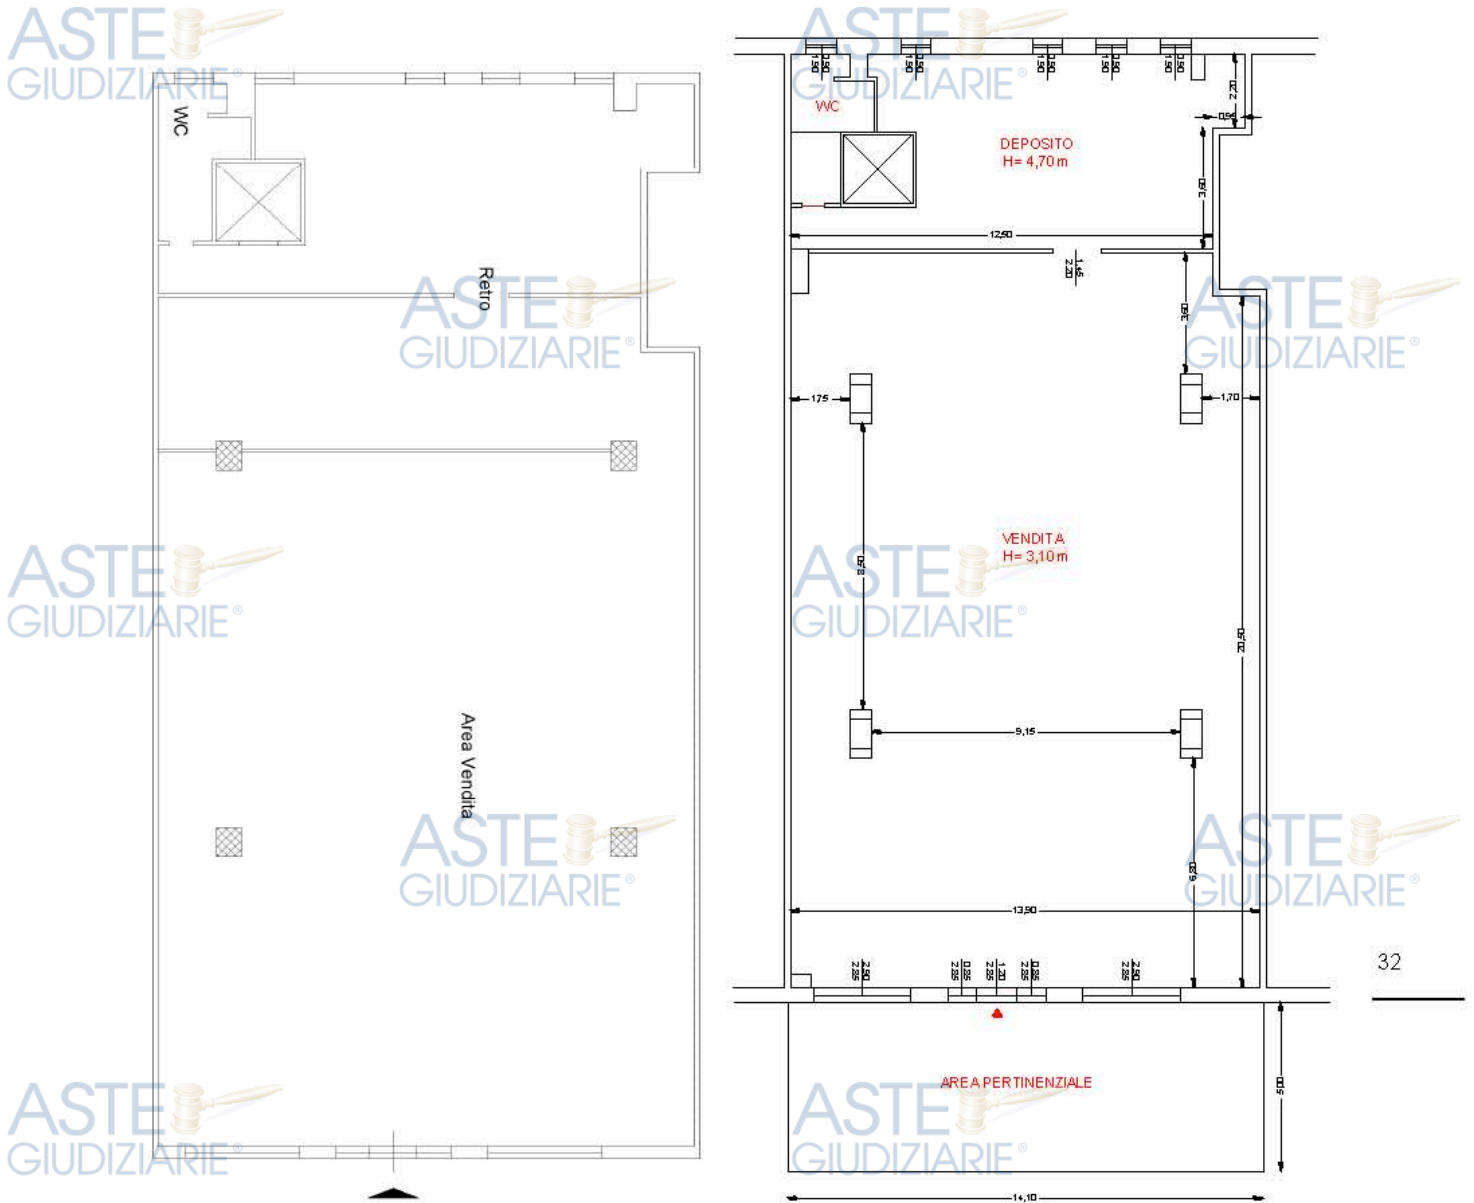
Raffronto planimetria catastale (a sinistra) e da rilievo (a destra) - Subalaterno 27
